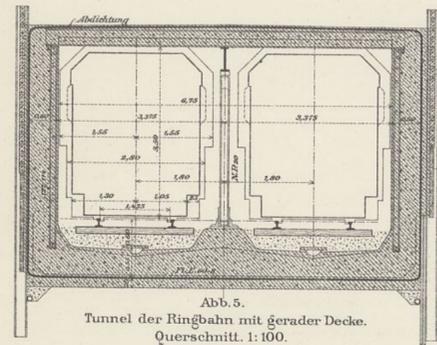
Tunnel der Ringbahn mit gerader Decke. Querschnitt. 1: 100.
